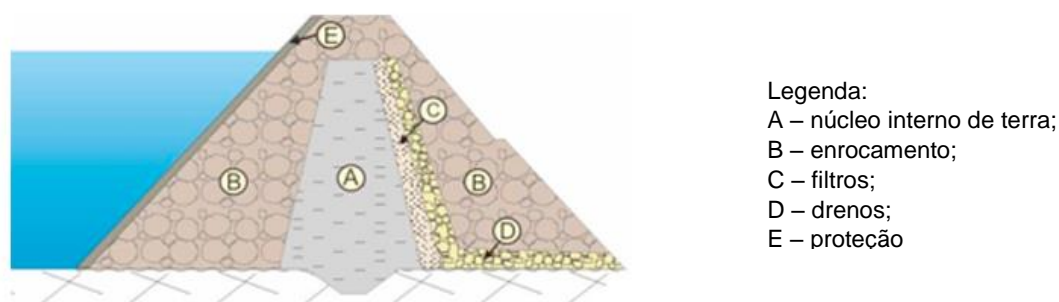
Barragem de terra de perfil zonado (fct.unl.pt)
